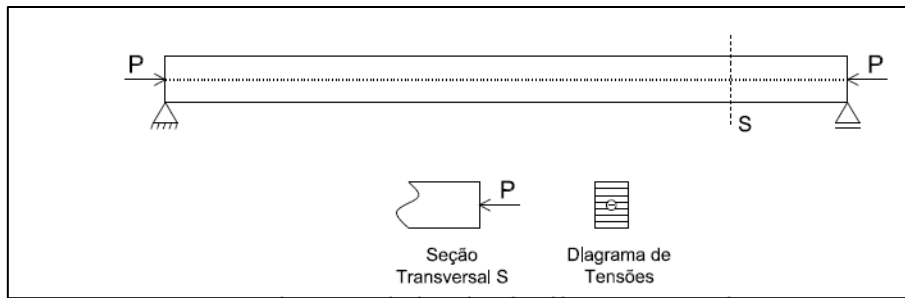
Viga isotática submetida à protensão centrada (GOMES JUNIOR, 2009)
